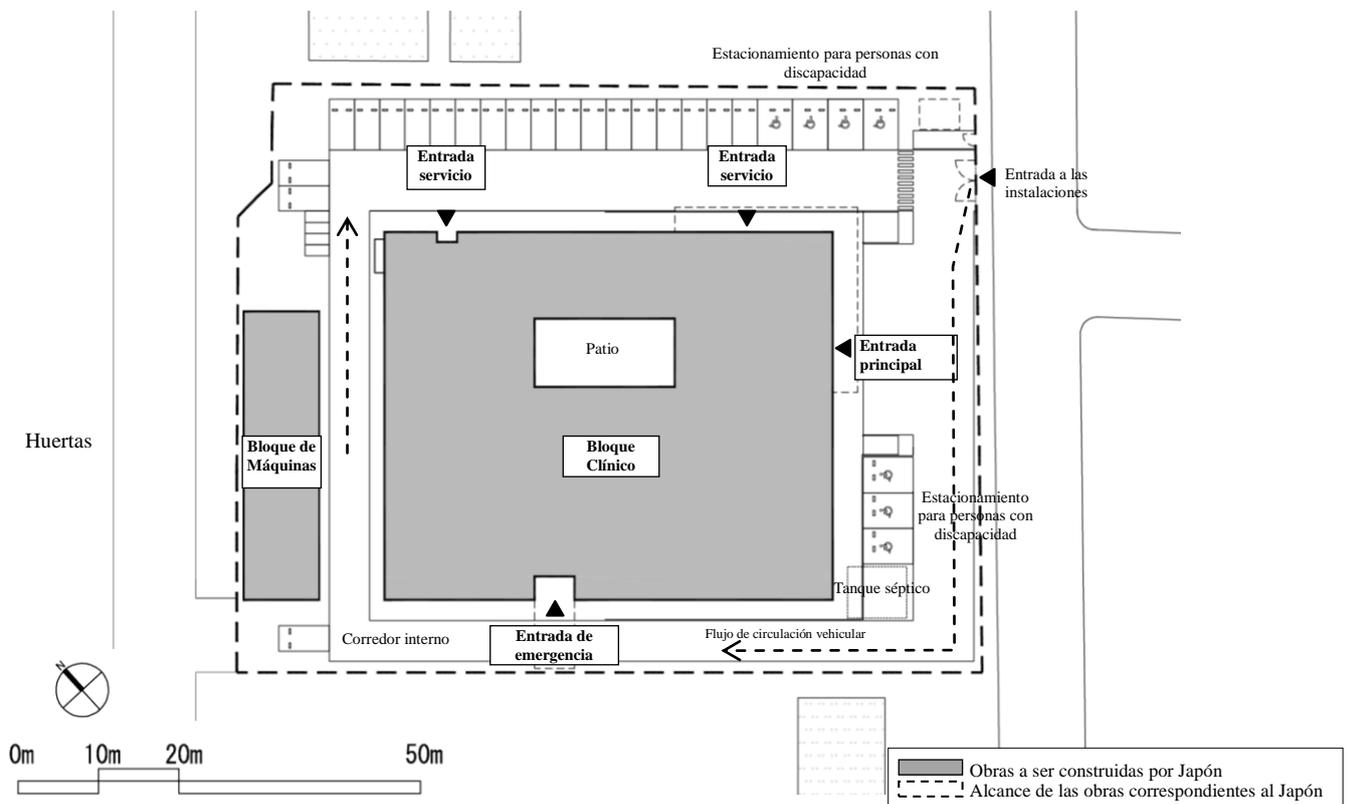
Plan de disposición de las instalaciones del C.S. Santa Rosa
